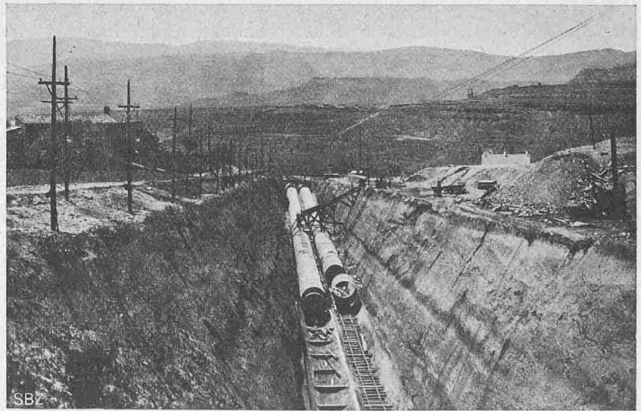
Rohrleitungsmontage; Schüttgerüst für die Betonierung, die der Montagestelle auf rund 30 m Abstand folgt.
